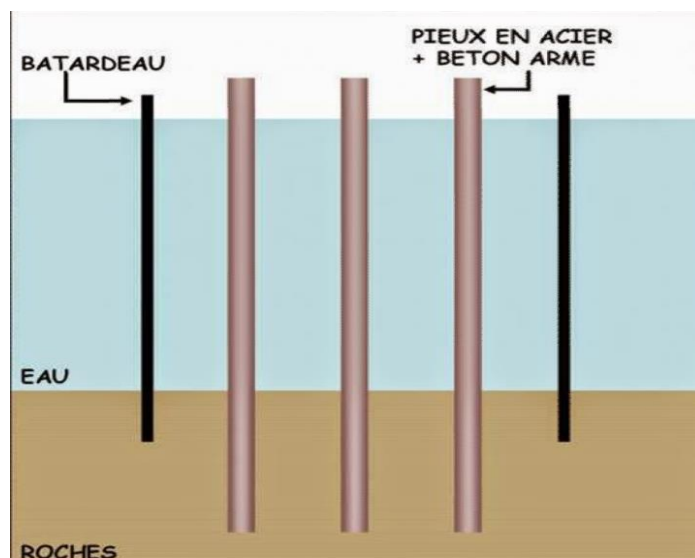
Schéma en coupe de la construction des piles : après la mise en place du batardeau et des pieux
